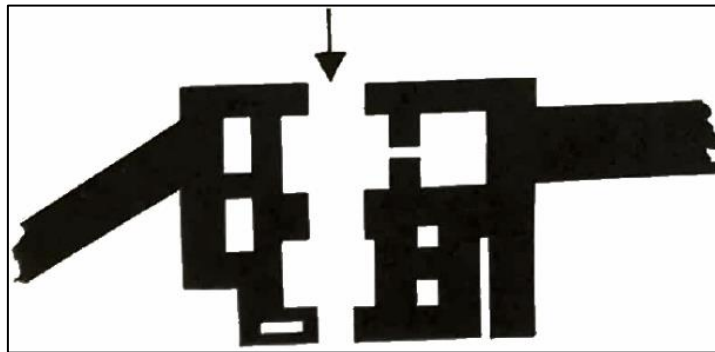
Porte AIN SHEMS, Egypte. Source Pierre RECOLLE⁷⁷
